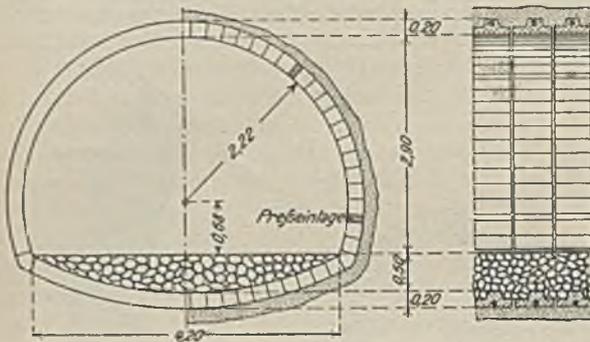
und 7. Leichtere Ausführung des nachgiebigen Eisenbetonausbaus.
